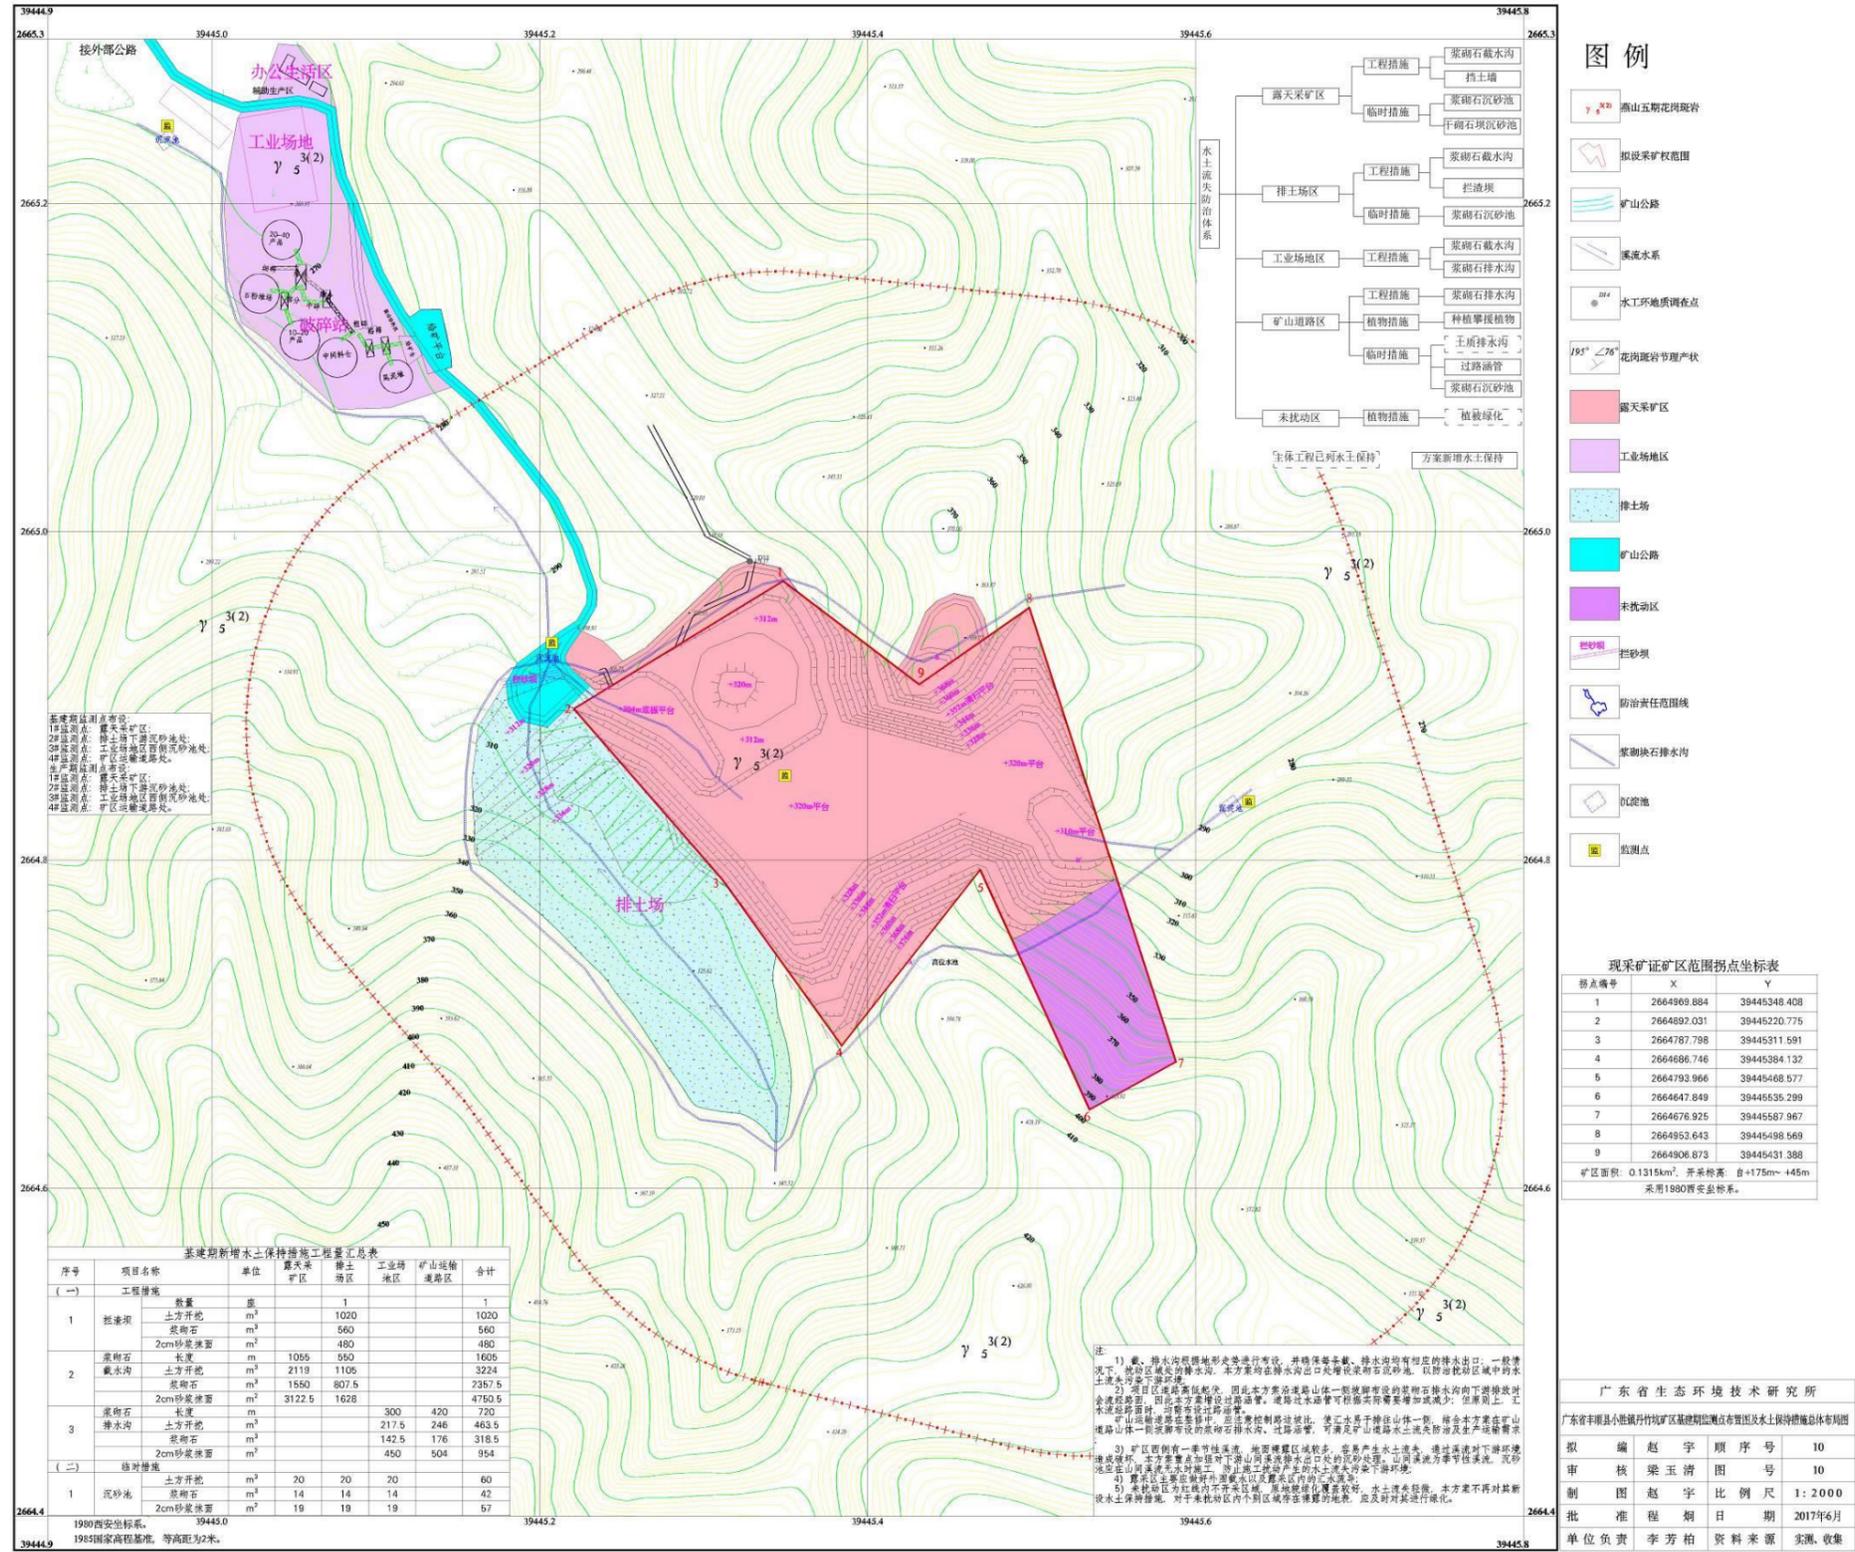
矿区防治分区和典型生态保持措施平面布置示意图
